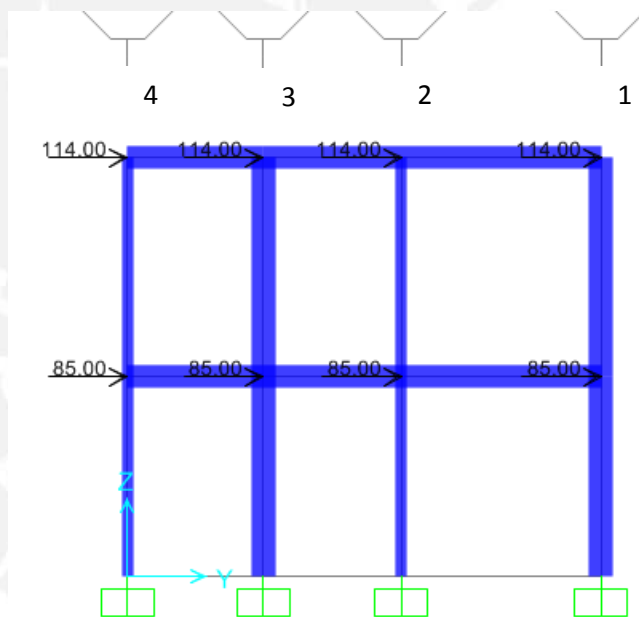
Pórtico eje B – Fuerzas Horizontales en Y (ejes SAP2000)
